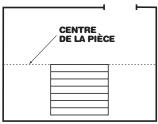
Fig. I – Disposition à sec pour déterminer la largeur de la dernière planche.
